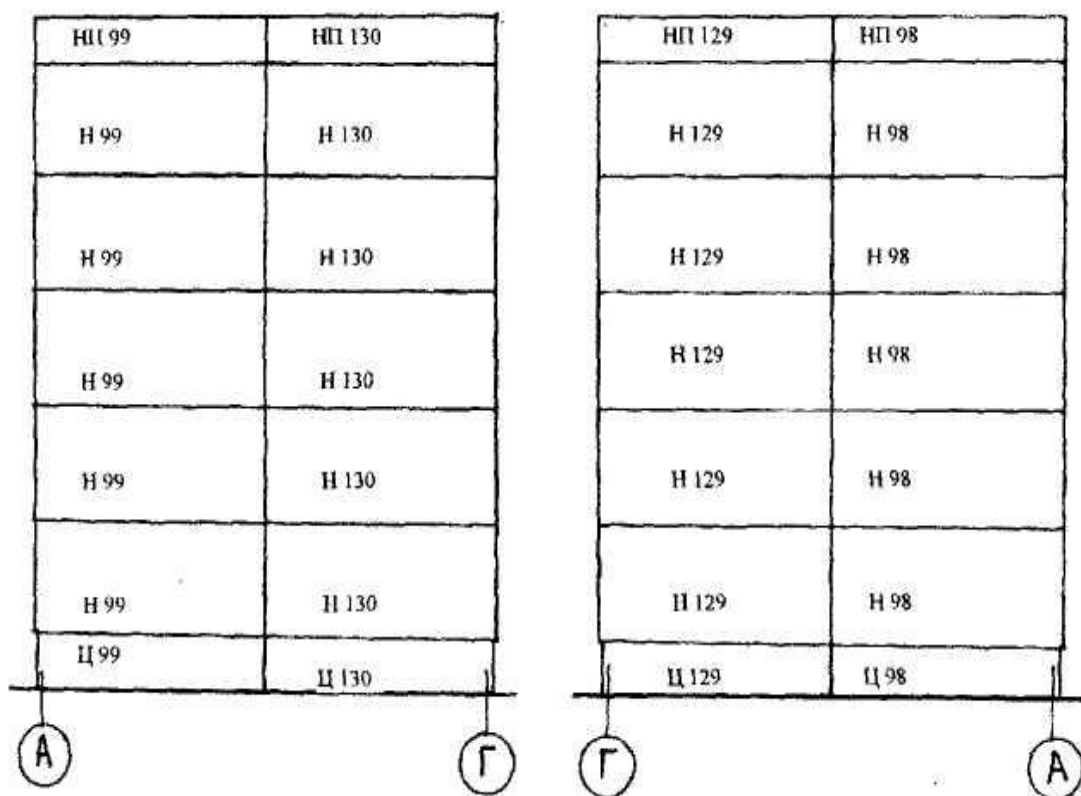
Монтажные схемы торцовых фасадов жилого дома
